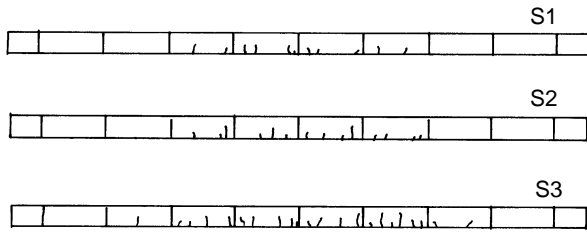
最終ひび割れ状況(縦線間隔 500mm)
